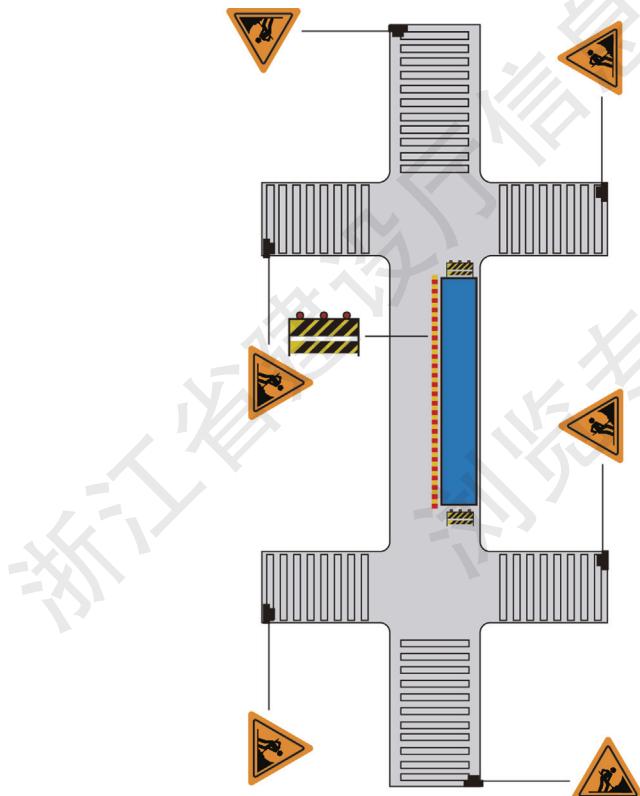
1 过街天桥桥面养护作业控制区布置示意
